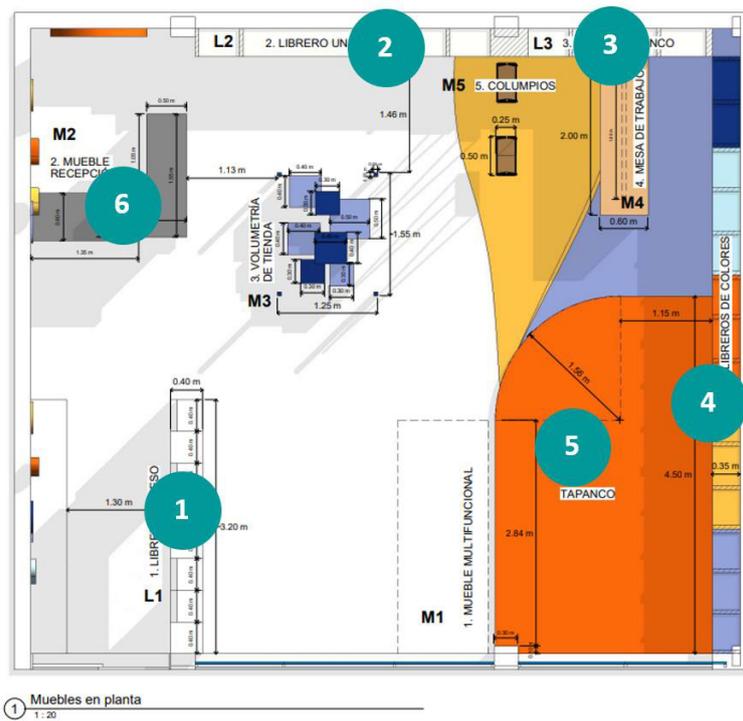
Planta Arquitectónica del espacio identificando los alcances del proyecto, Imagen proporcionada por Instituto Educativo Santa Fe de Guanajuato.
